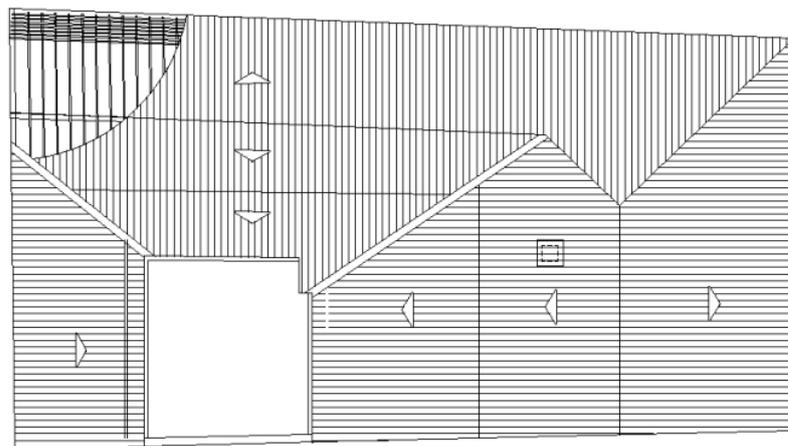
Ilustração de Planta de Cobertura e desenho do lote.
